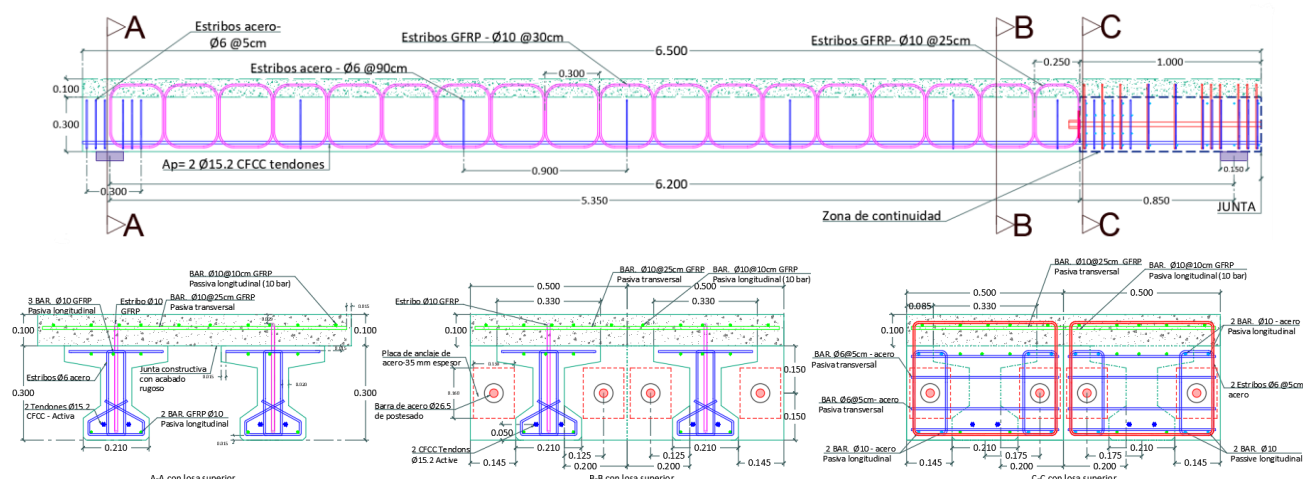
Alzado de una de las vigas y secciones transversales de armadura.
